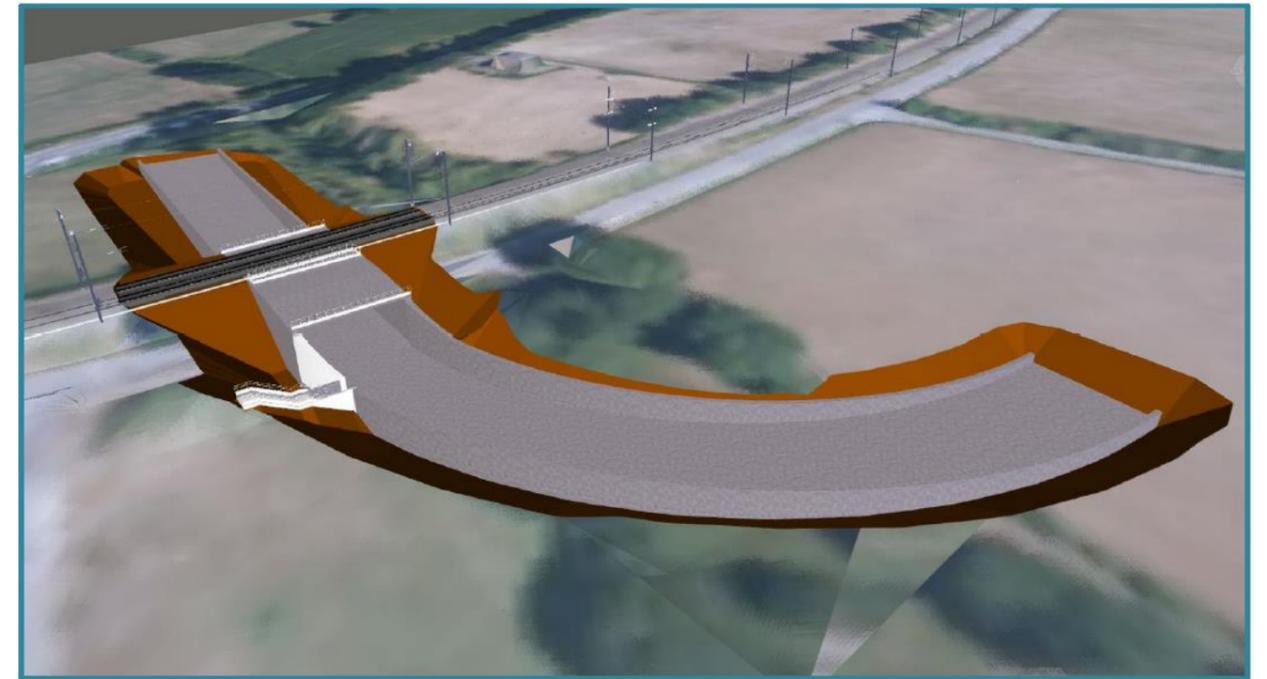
MISE EN PLACE DU CUVELAGE DE LA RAMPE SUD ET DE L'ESCALIER
